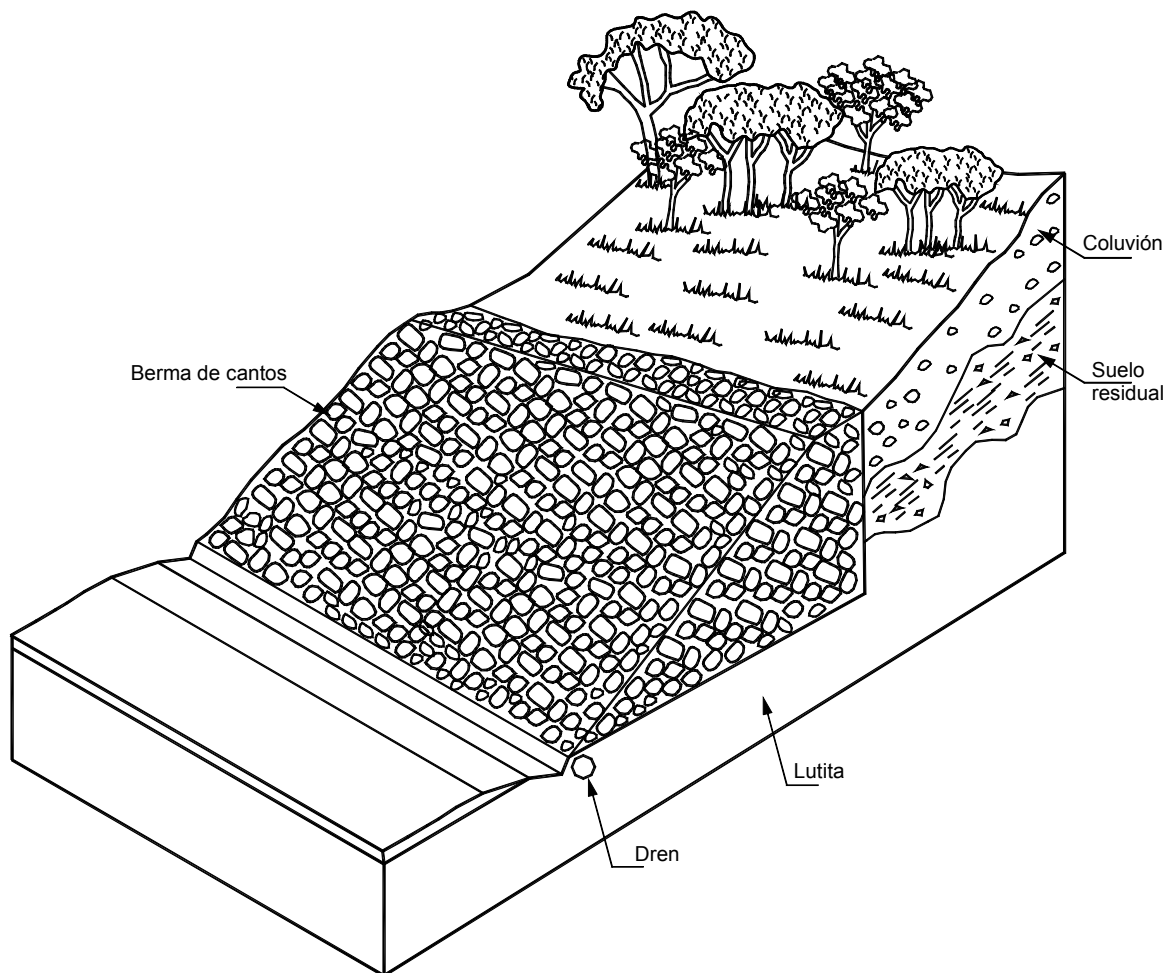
Ejemplo de protección utilizando un muro masivo en piedra.
